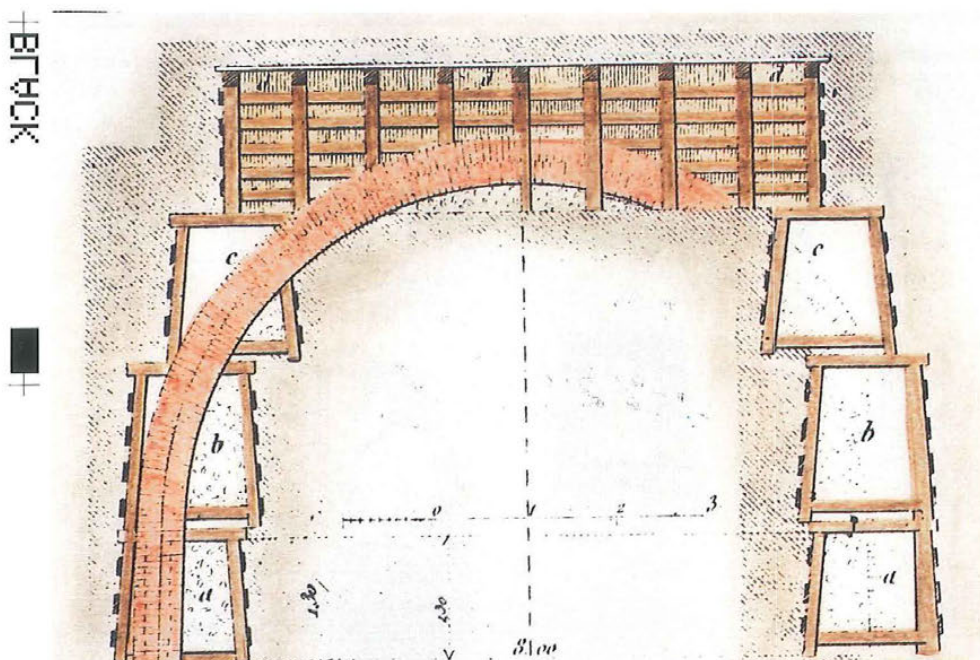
Autre mode de construction d'un tunnel lorsque l'on se trouve en présence d'un fondi.
